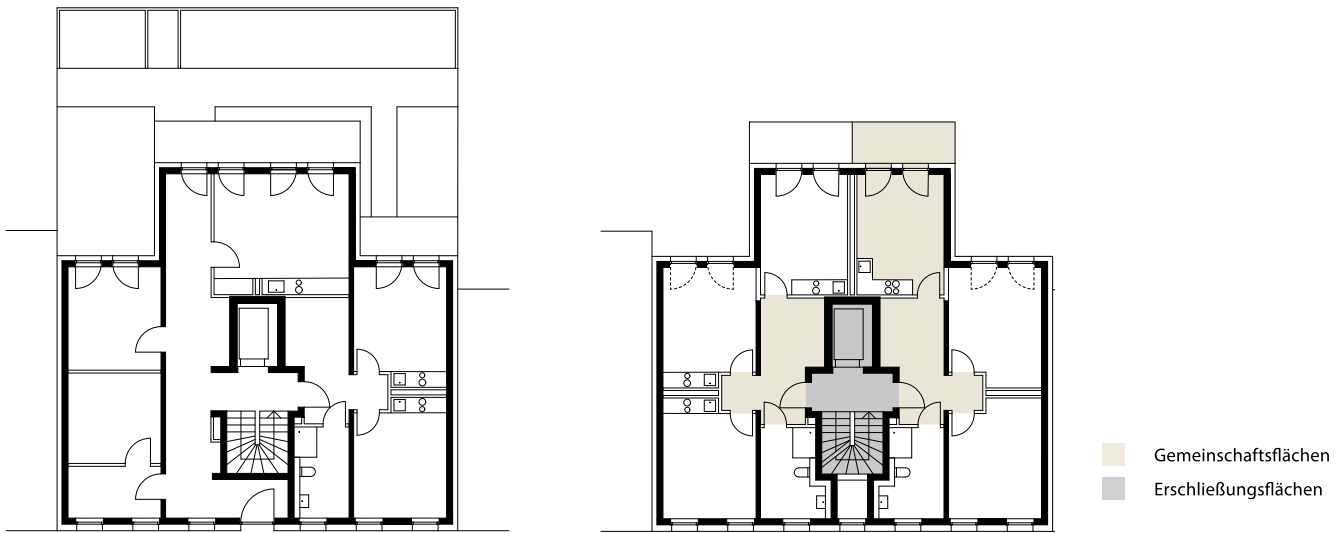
Grundriss Erdgeschoss und Regelgeschoss mit innenliegendem Erschließungskern, M. 1: 300 [© BF Vario]
